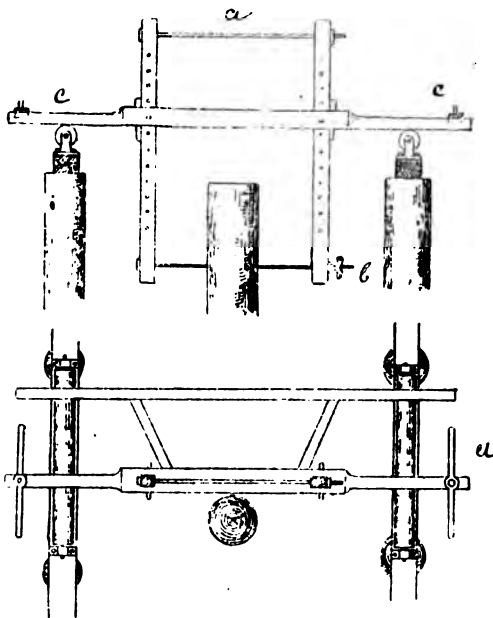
Ansicht und Grundriß einer Pilotensäge. — a Holzrahmen, b Sägeblatt, c Sägearm, d Gerüst, e Pilote.
